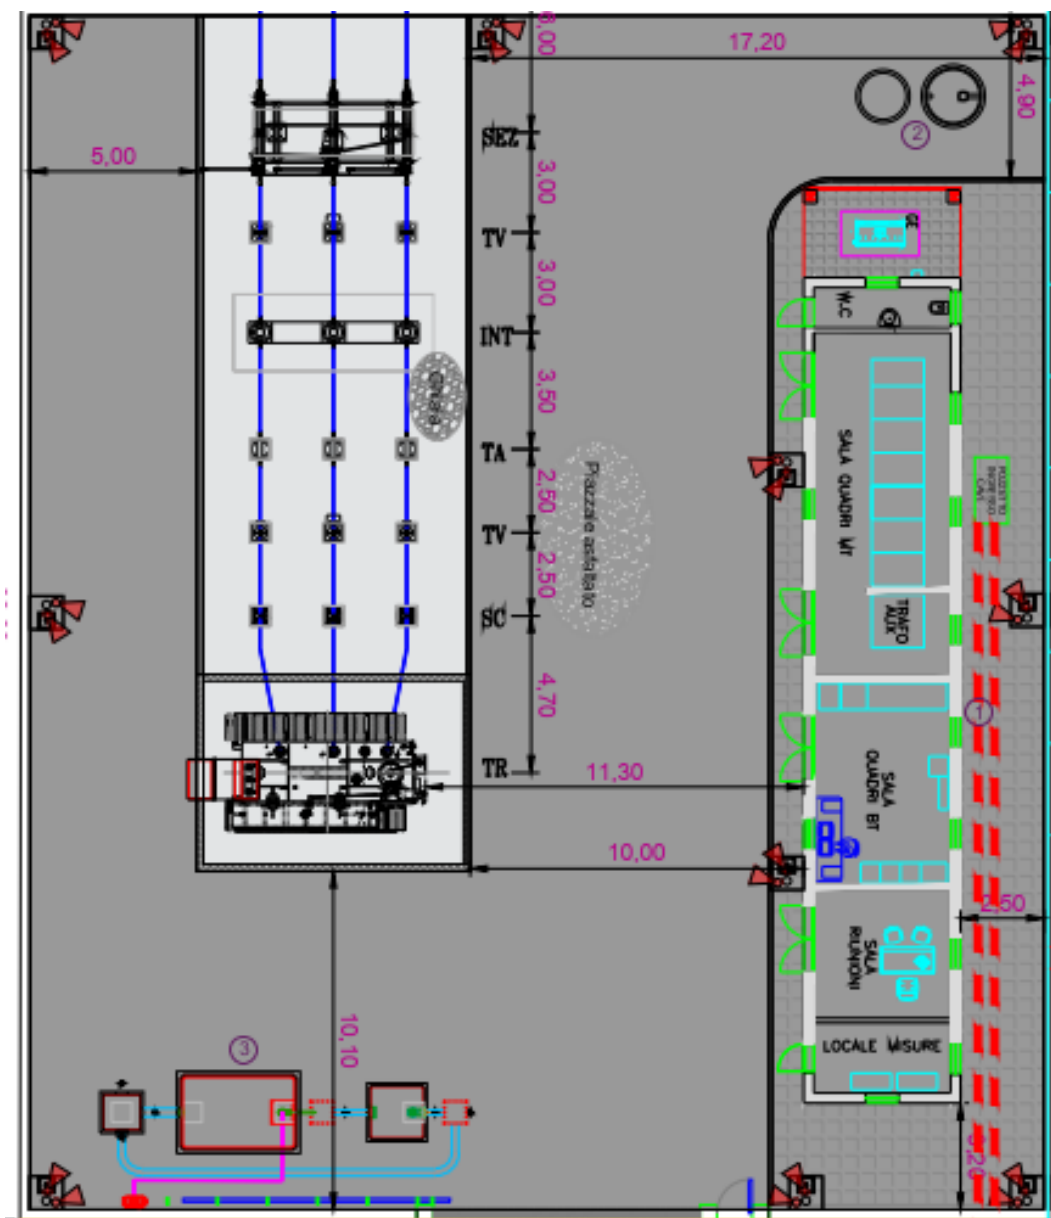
Planimetria elettromeccanica stazione utente 150/30 kV
